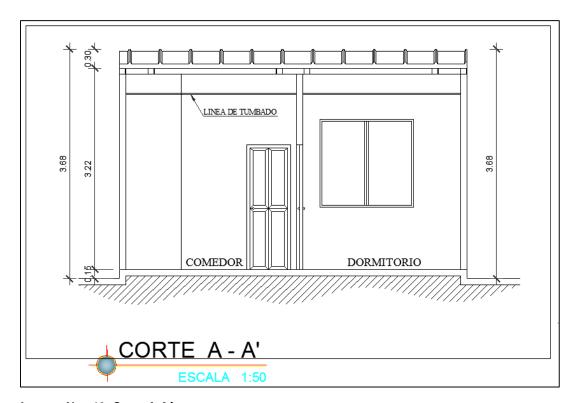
Corte A-A´ Fuente: Rosa Guambo Gamarra
